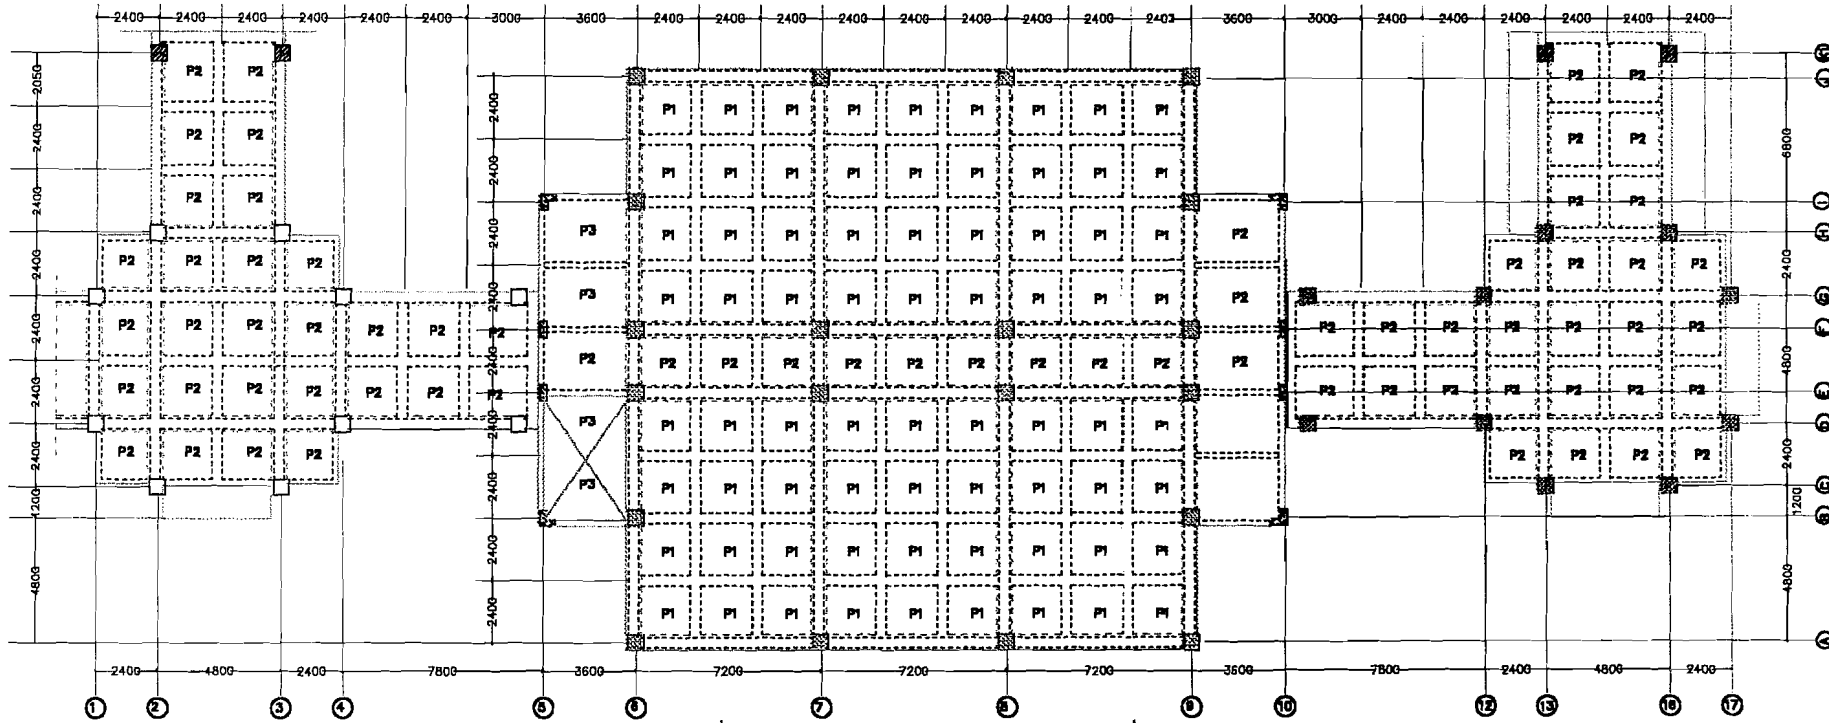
Pekerjaan Penulangan Plat Lantai dan Instalasi Listrik
